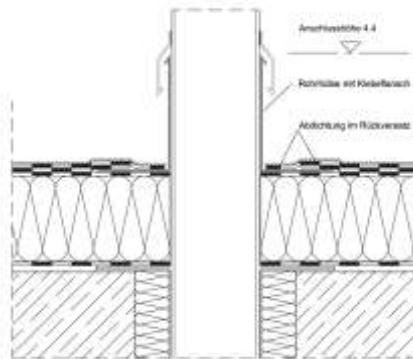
5: Beispiel für eine Rohrdurchführung durch ein wärmegedämmtes, nicht belüftetes Dach mit Abdichtung auf Beton
